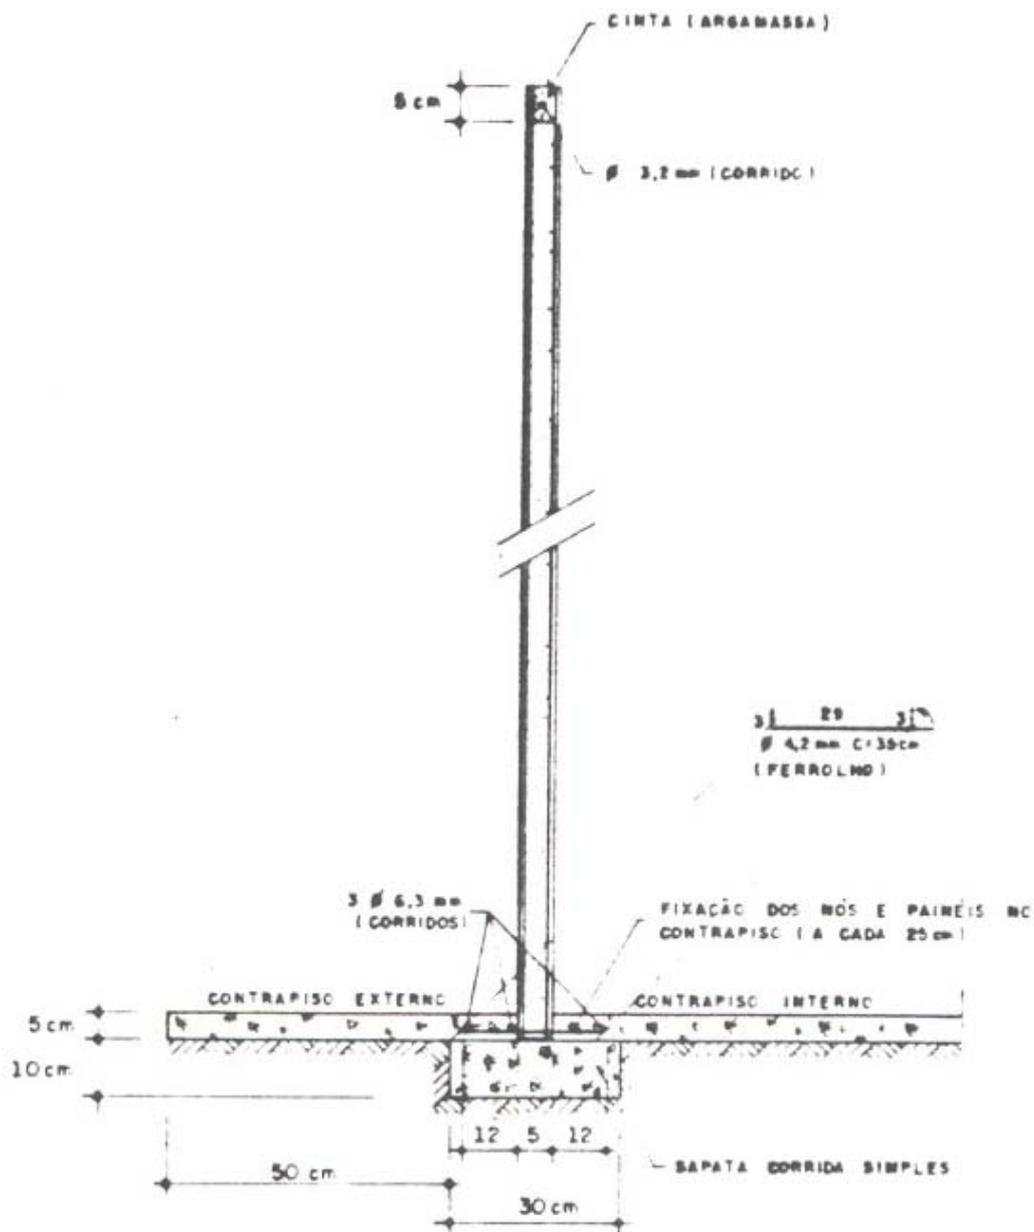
Detalhe da fixação dos painéis, elementos de ligação no contrapiso e cinta de amarração superior
